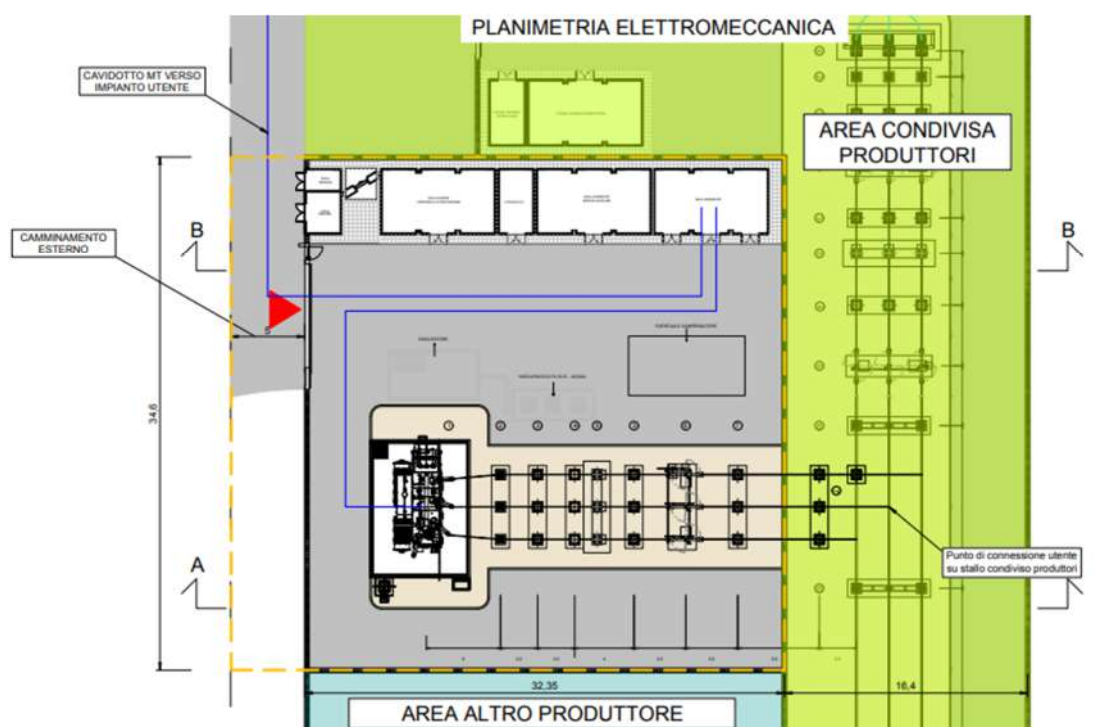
Planimetria della SSE utente di trasformazione e connessione da SKF_T_57_A_D_A_1
